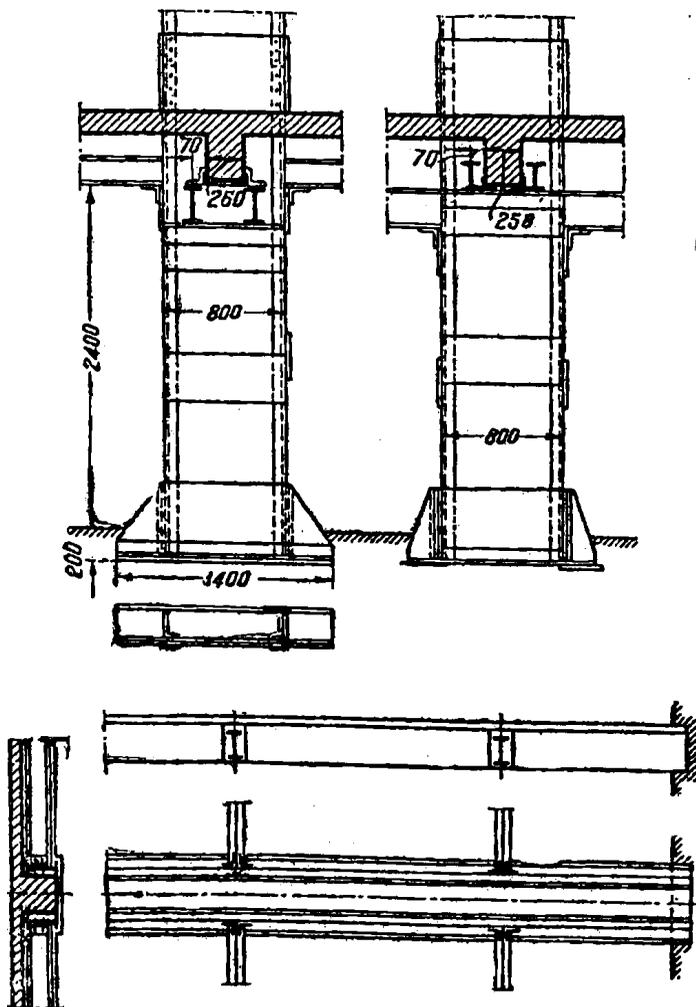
Применение металлических разгружающих конструкций для усиления железобетонных балок
